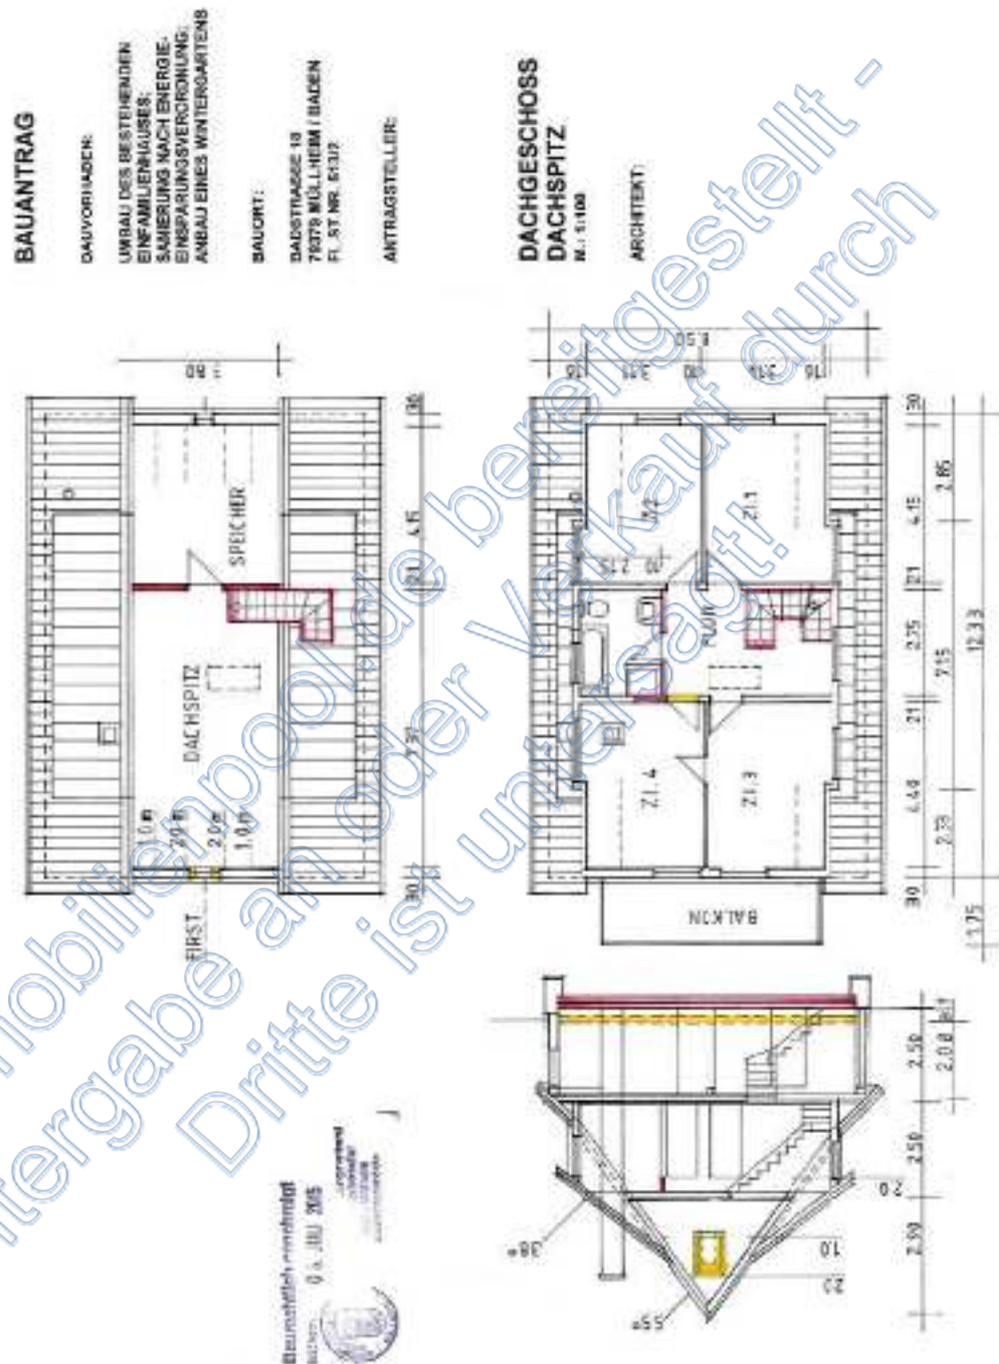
Grundrisse Dachgeschoss und Dachspitze, Schnitt
